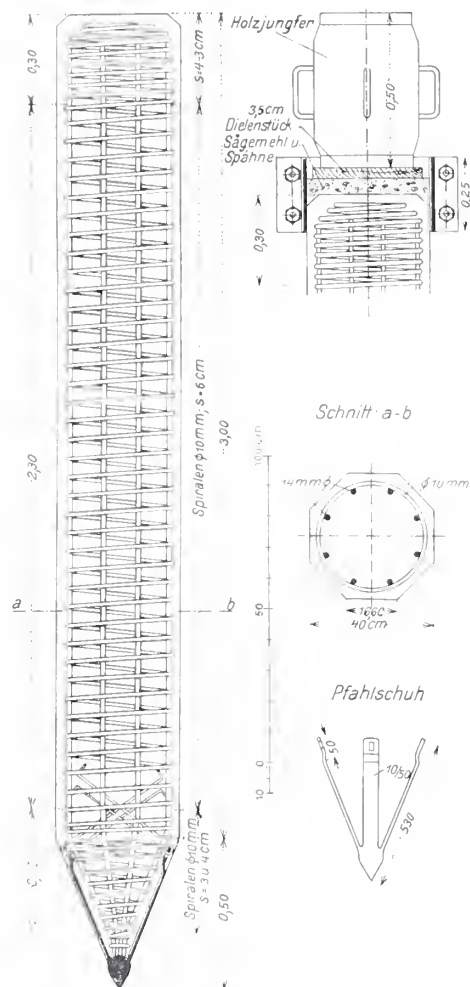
Eisenbetonpfahl. — 1 : 25.
